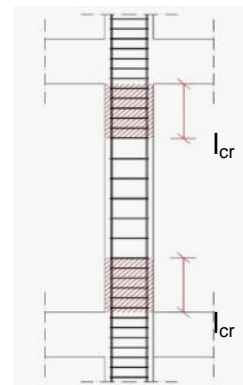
Zonas críticas dos pilares (adaptado de NP EN 1998-1, 2010);
